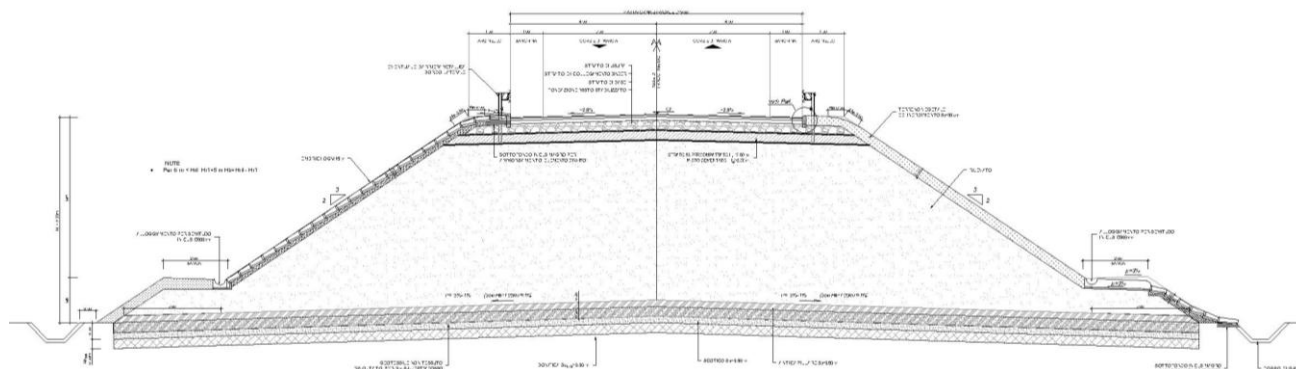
CAT. F1 sezione tipo in rilevato $H_{ril} > 6.00 \text{ m}$
